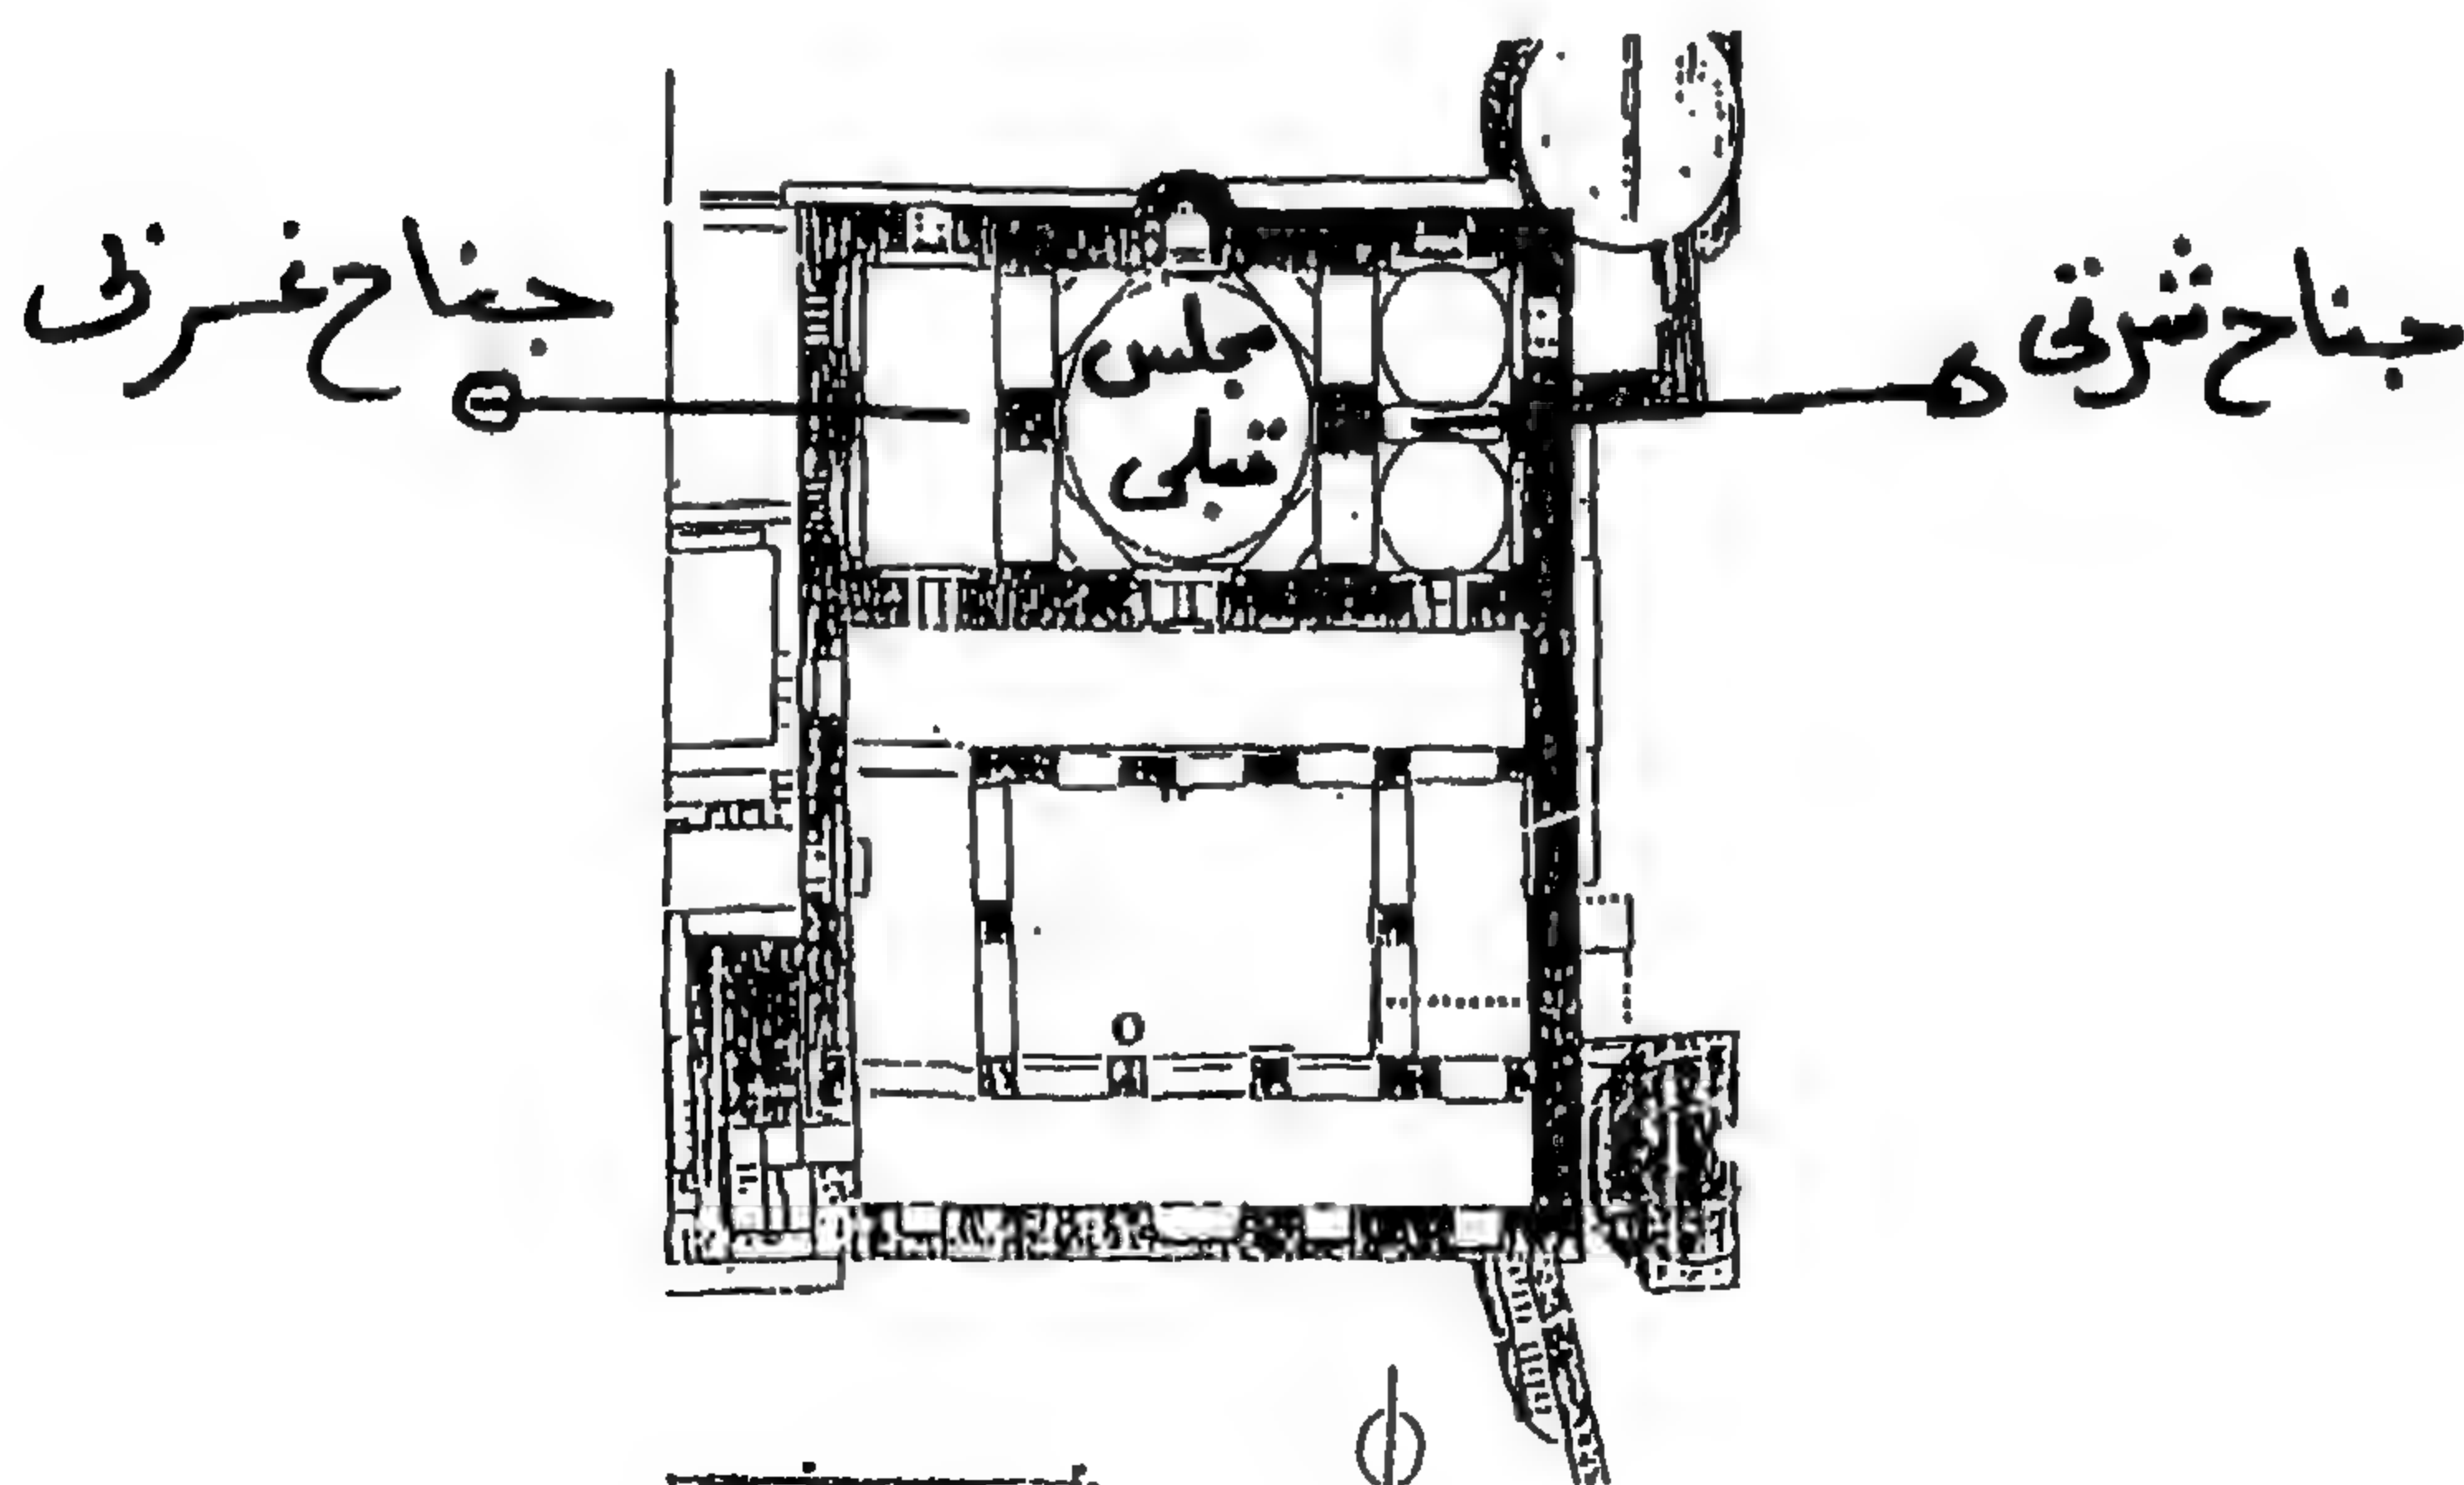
مسقط أفقي لجامع الملكة صفية بالقاهرة (عن المجلس الأعلى للآثار)
